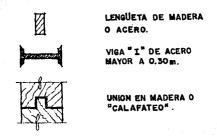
, PIEZAS DE UNION EN TABLONES PARA COMPUERTAS DE MADERA.
